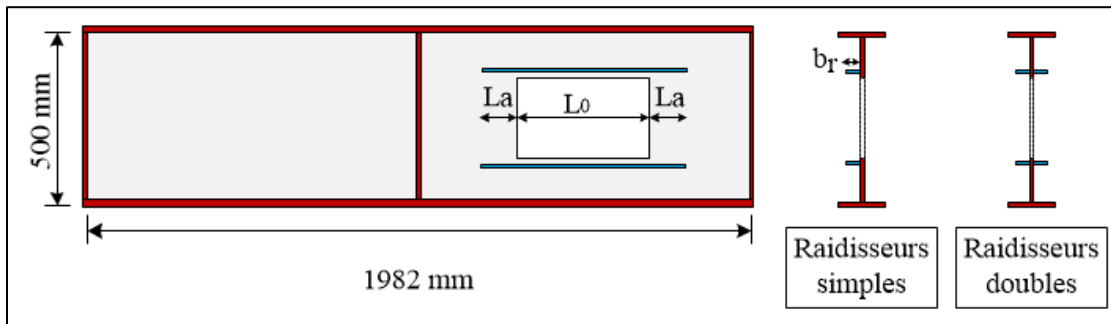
Paramètres des raidisseurs horizontaux avec ancrage
